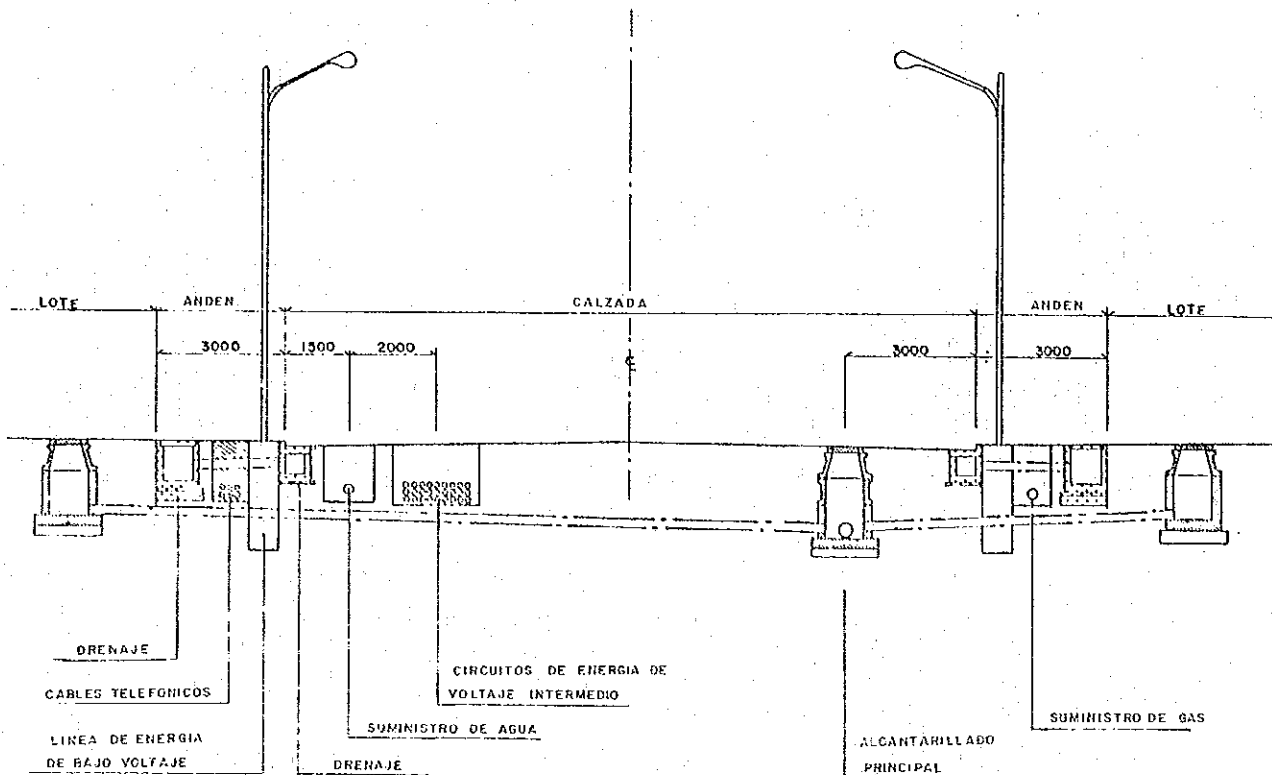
DISPOSICION TIPICA DE LAS LINEAS DE SERVICIO EN LAS VIAS
